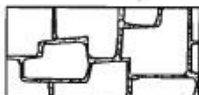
Tipologías de aparelhos construtivos de pedra.<sup>2</sup>
